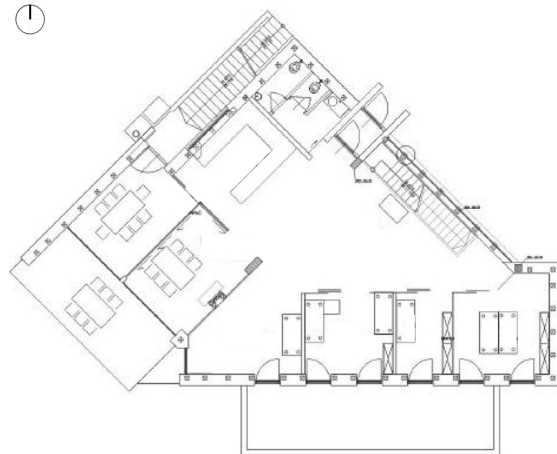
Pianta piano terra; Fonte: A. Themessl, 2004;
